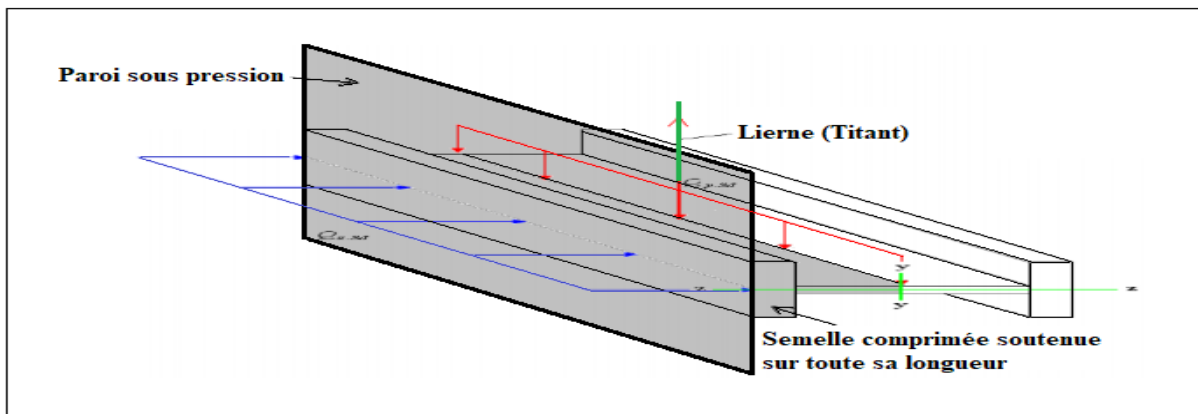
Semelle comprimée soutenue sur toute sa longueur.
